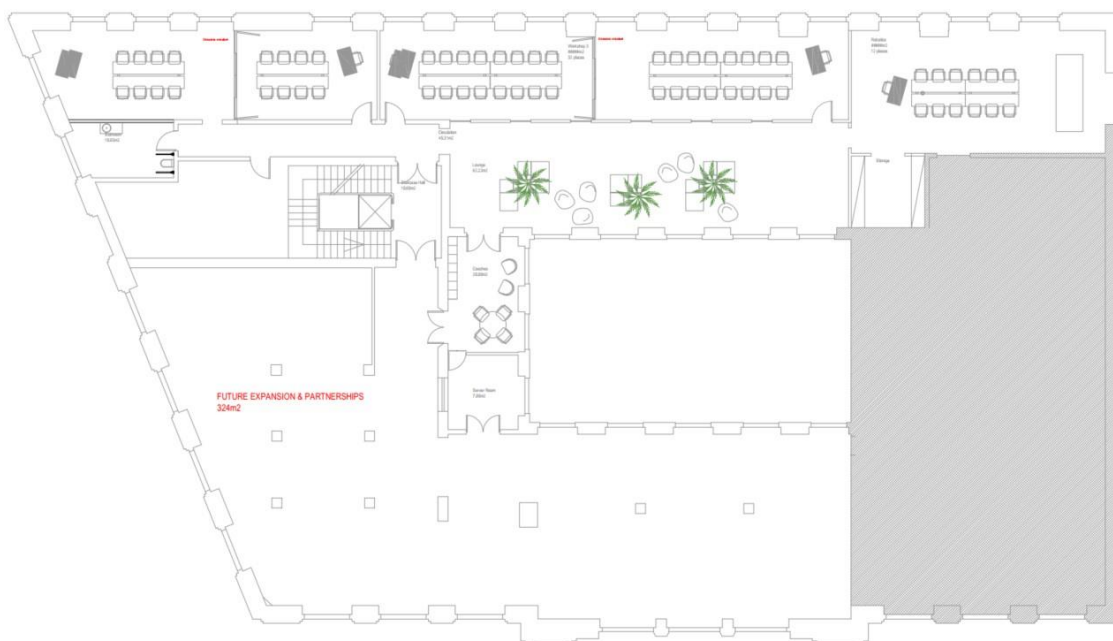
Edifício TUMO: planta do Piso 2.
